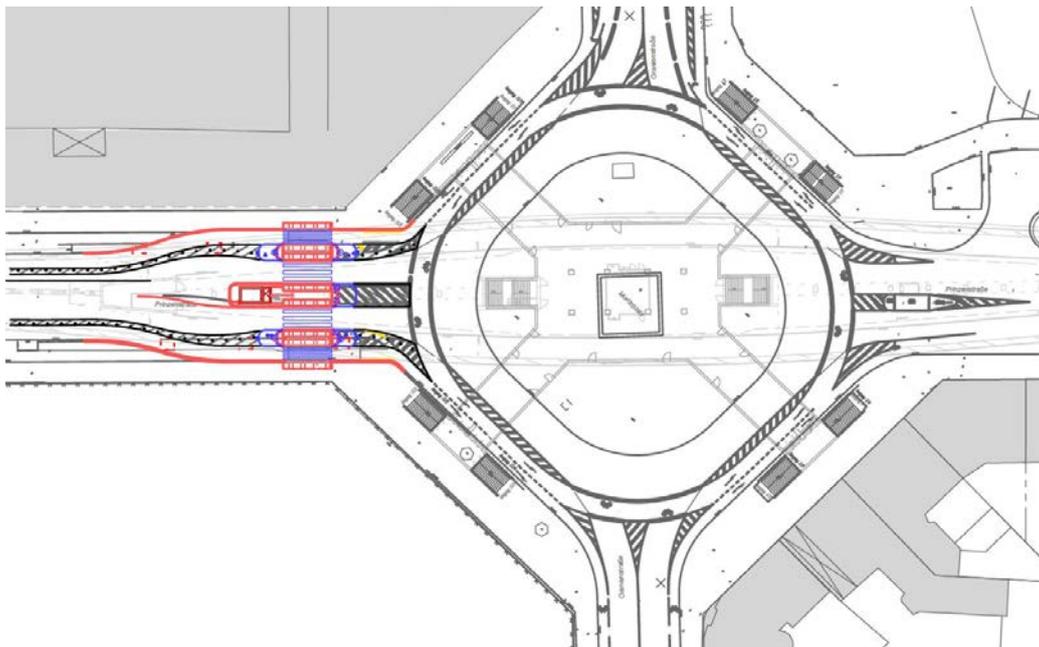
Übersicht mit Vorzugsvariante, Bildquelle: Plan PG002a artus^{GmbH}
